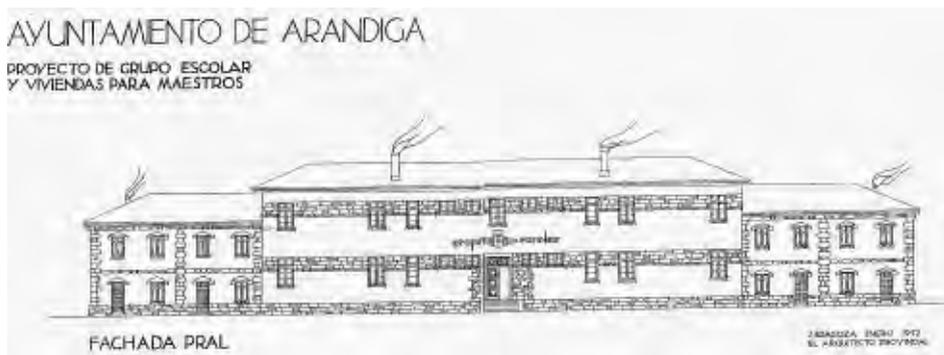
Fachada principal de las escuelas y viviendas para maestros de Arándiga, según el proyecto firmado por el arquitecto Teodoro Ríos en enero de 1932 (Archivo de la Diputación Provincial de Zaragoza).
